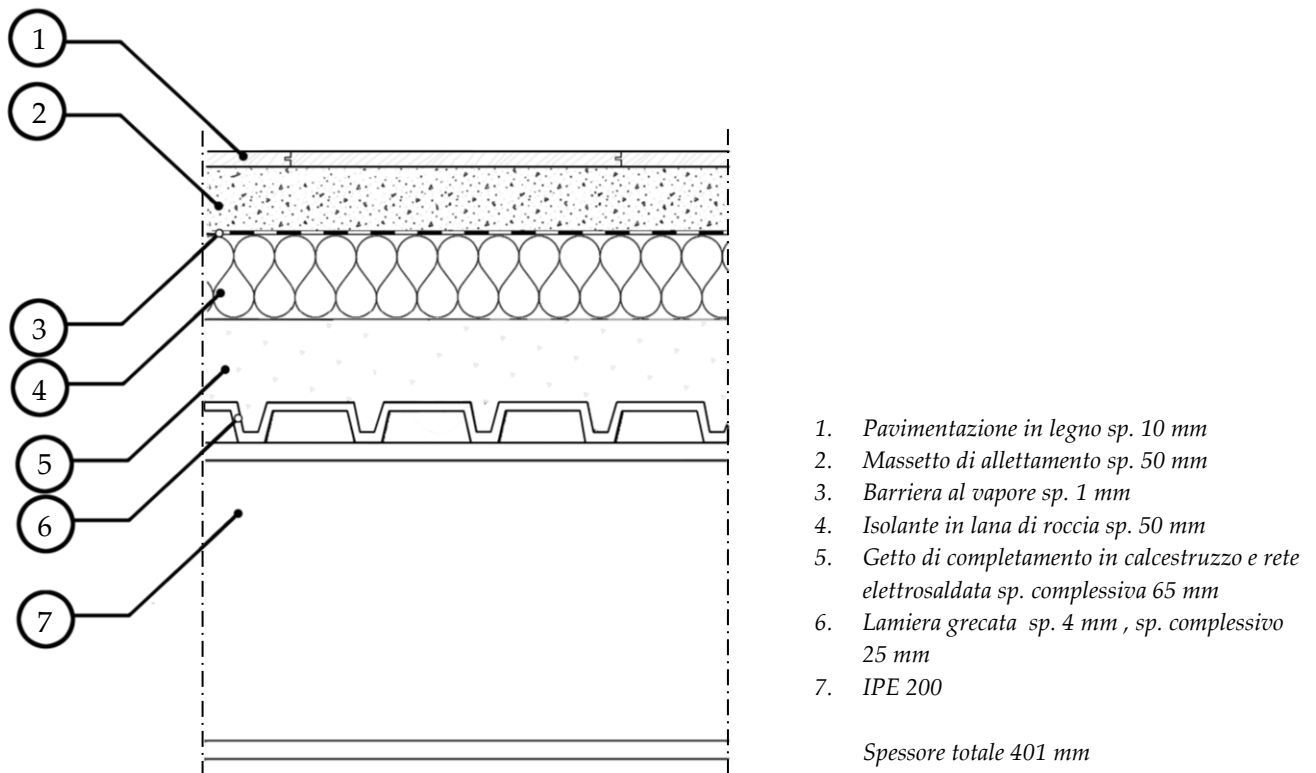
Particolare del solaio collaborante interno isolato in progetto al primo piano dell'edificio tettoia.
